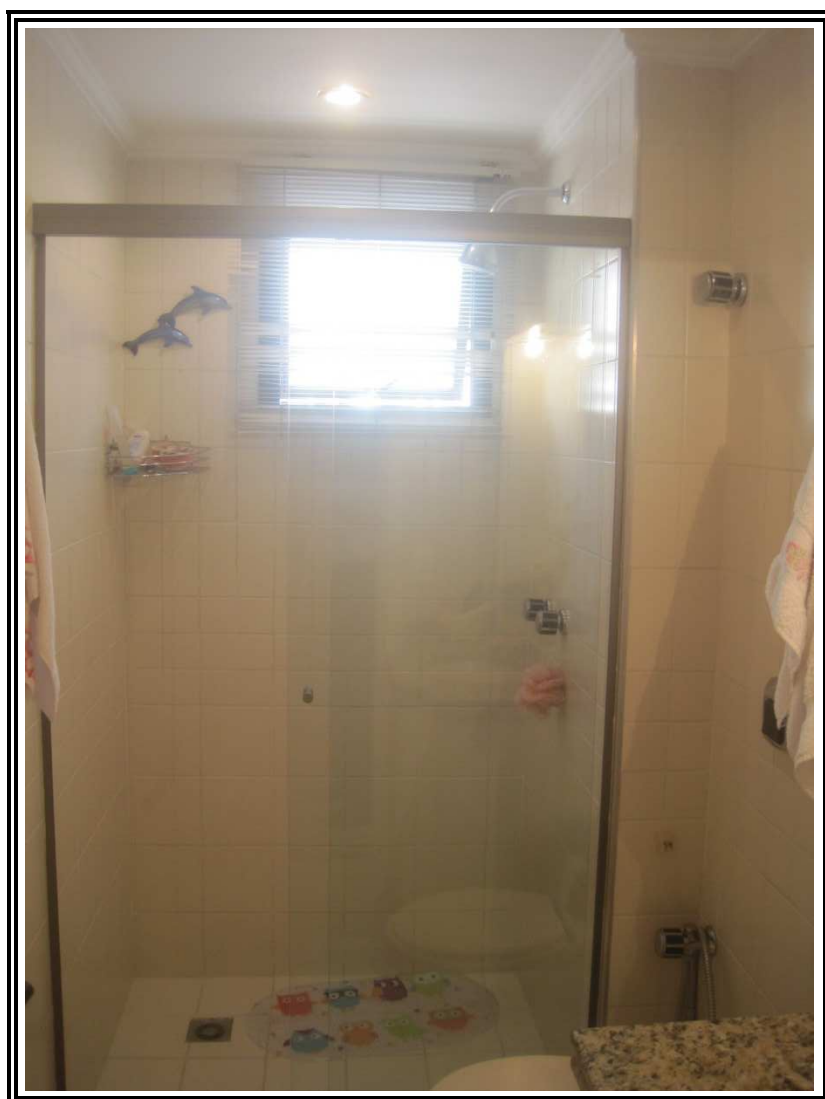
Vista do banheiro do dormitório 03 (suíte)
